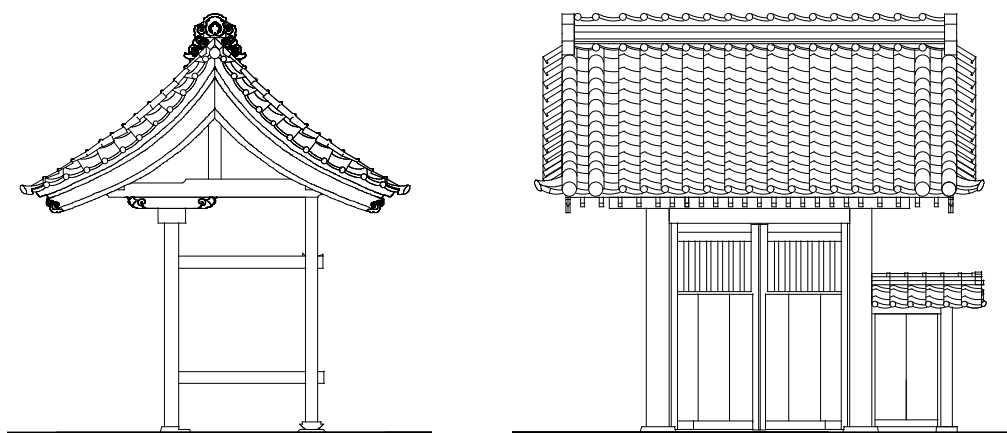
山門立面図 (左：側面図(南)、右：正面図(西)) 1/100
